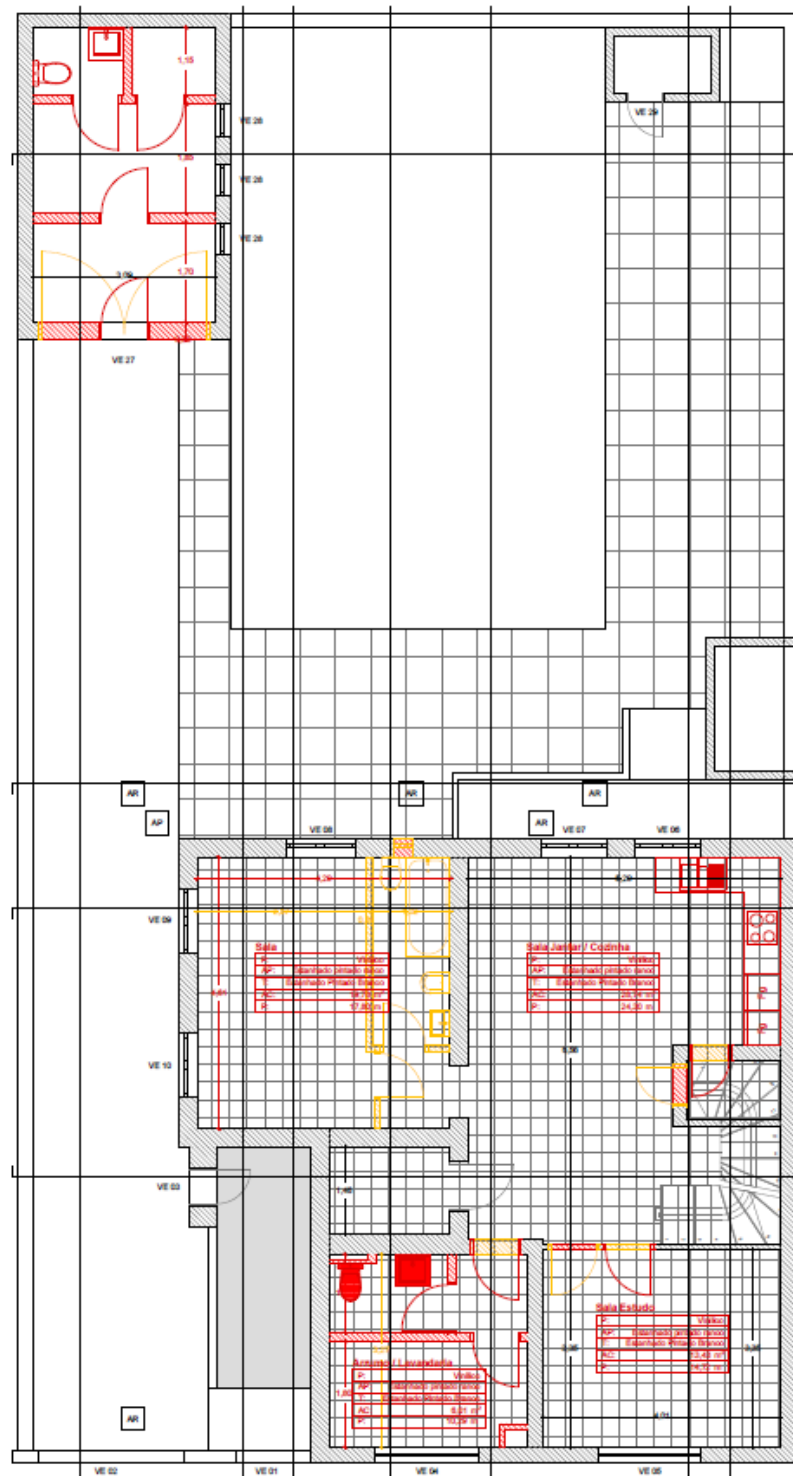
Planta (Vermelhos e Amarelos) Cave e Exterior
